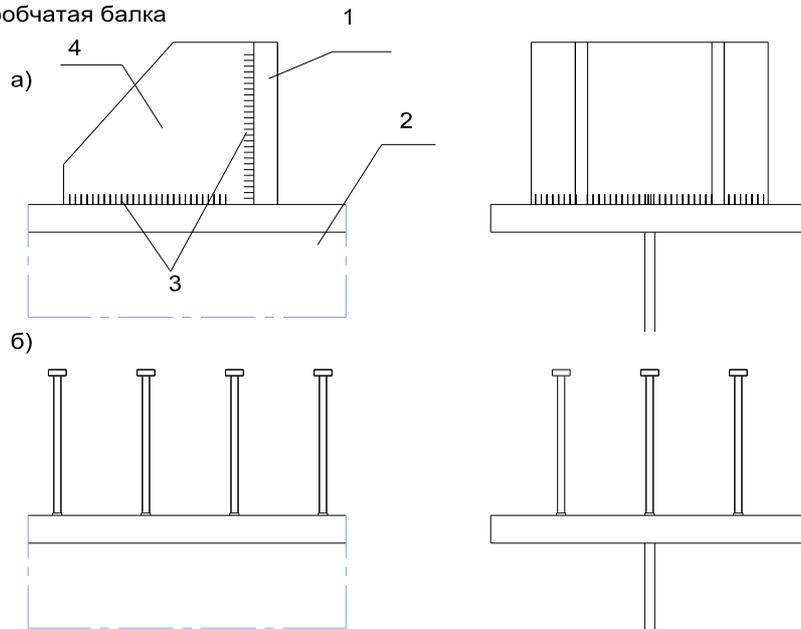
Конструкция упоров для объединения в совместную работу стальных балок и железобетонной плиты: а-жесткие упоры; б-гибкие упоры с головками: 1-лист; 2-балка; 3-сварные швы; 4-ребра
